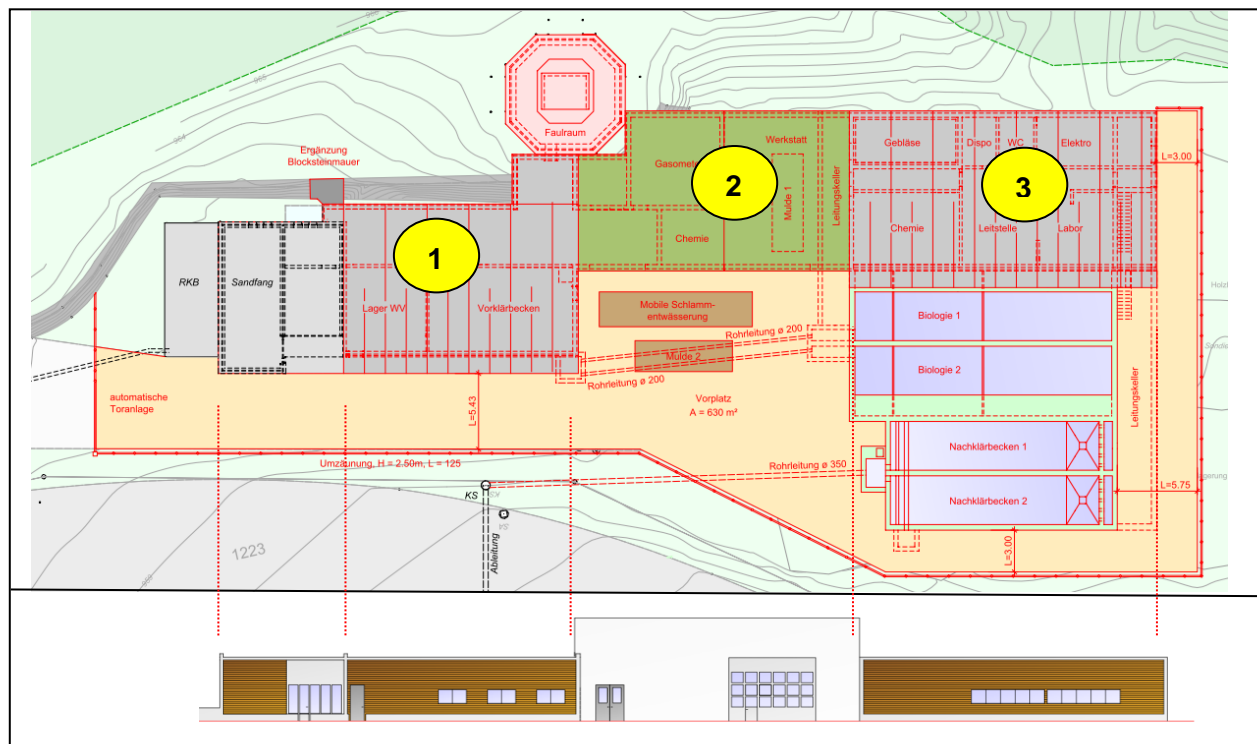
Grundriss und Fassadenansicht Betriebsgebäude.
